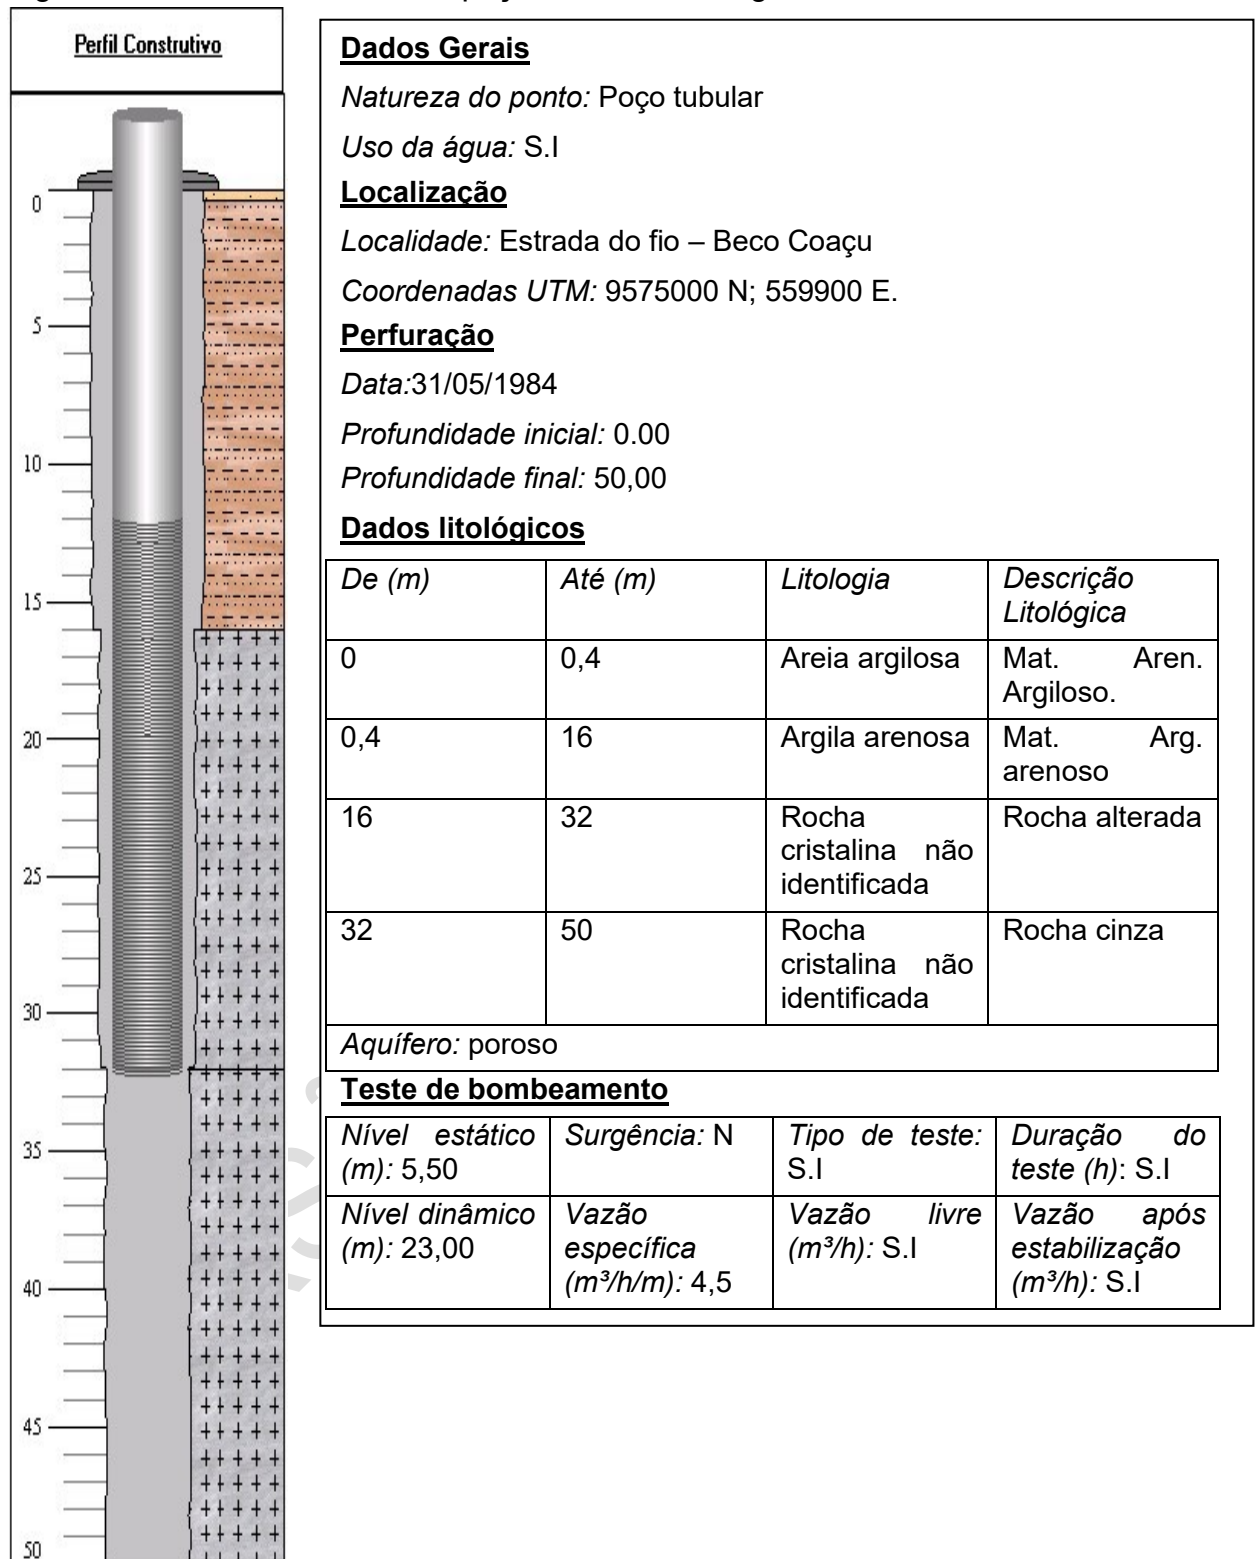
Perfil construtivo do poço 4: ao sul da Lagoa da Precabura.
